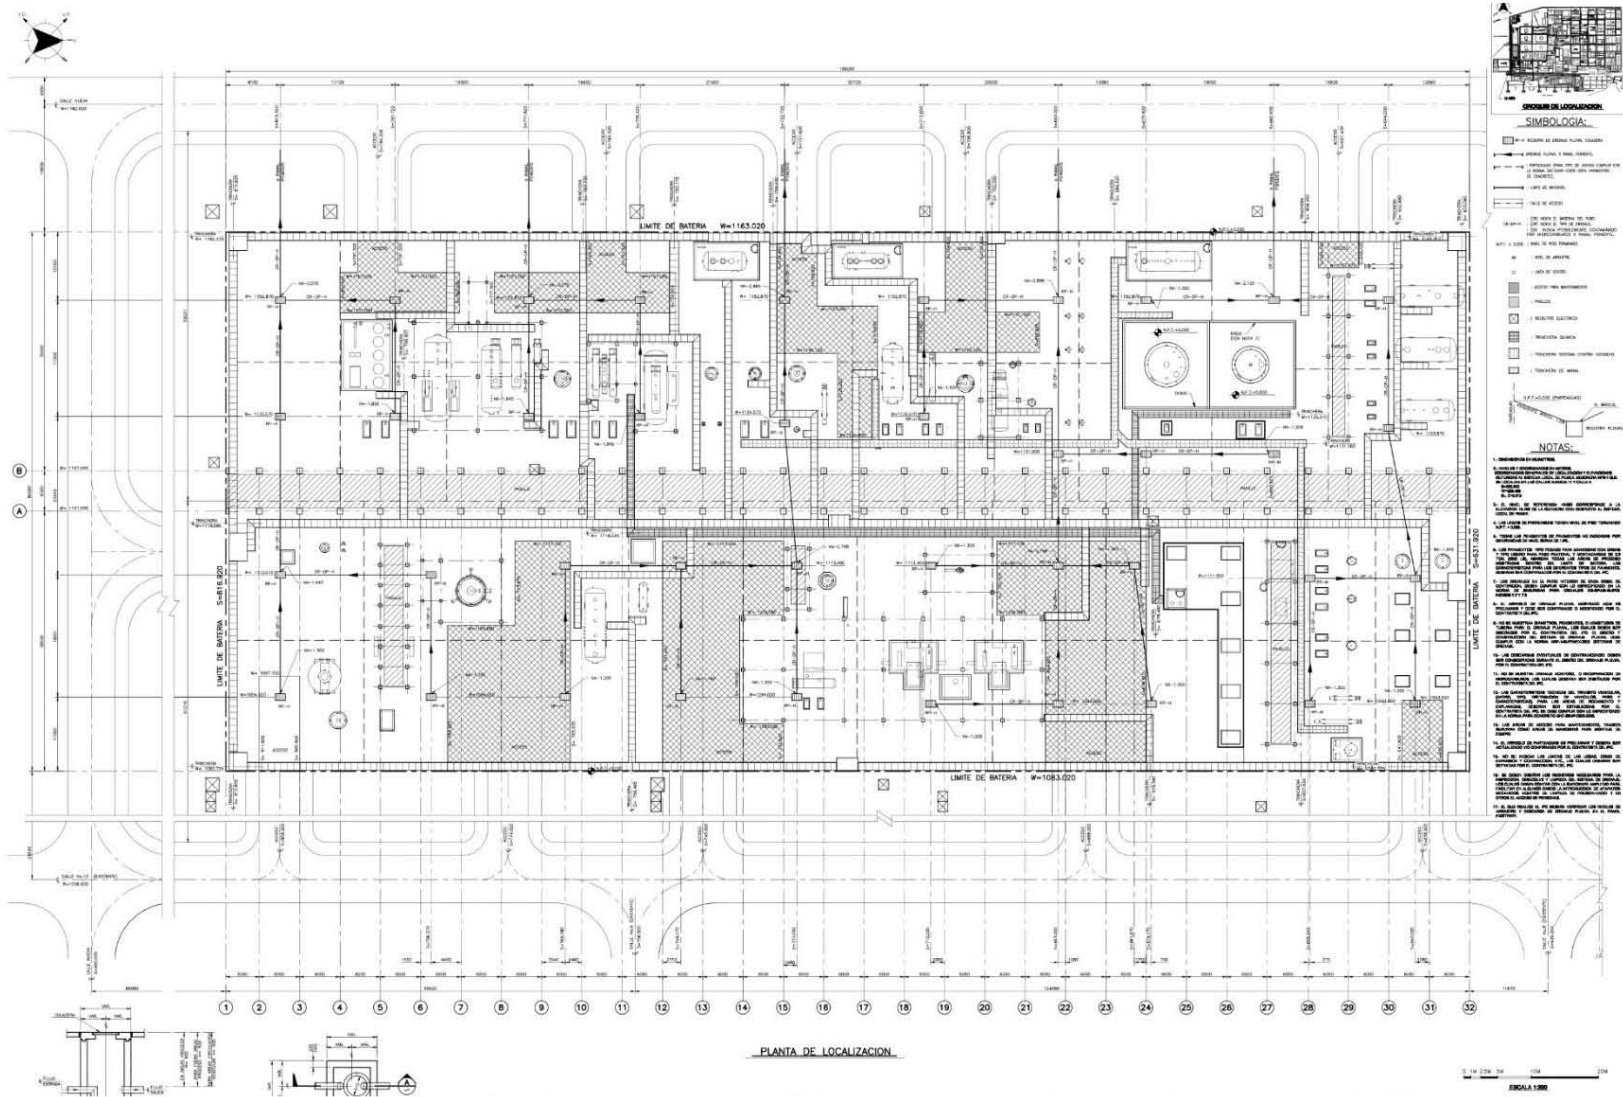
Localización de Niveles y Pavimentos PLANTA-A
